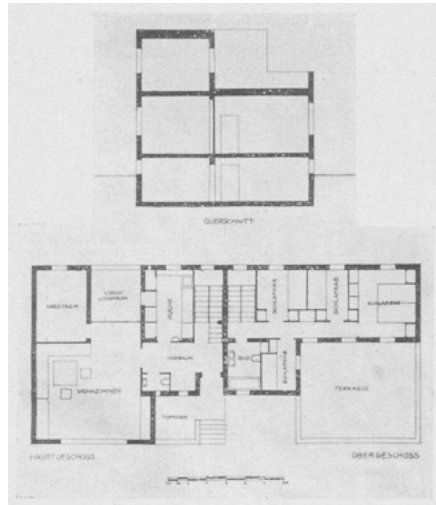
Grundrisse und Schnitt, Reihenhäuser II. S. Abb. 12, 13, 14 u. 15
